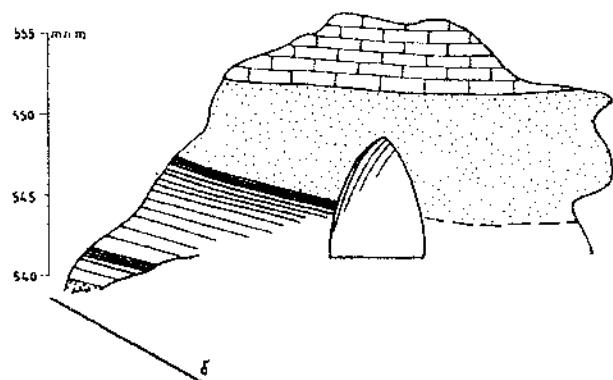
Podčelný profil tunelem s vyznačením hlavních poruchových pásem a litologických typů křídových sedimentů
